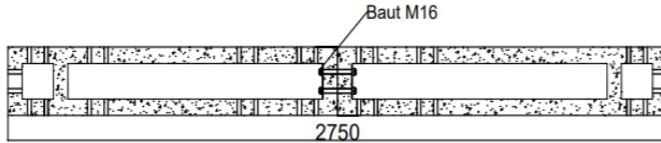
1 Denah sambungan re-desain yang ditinjau
